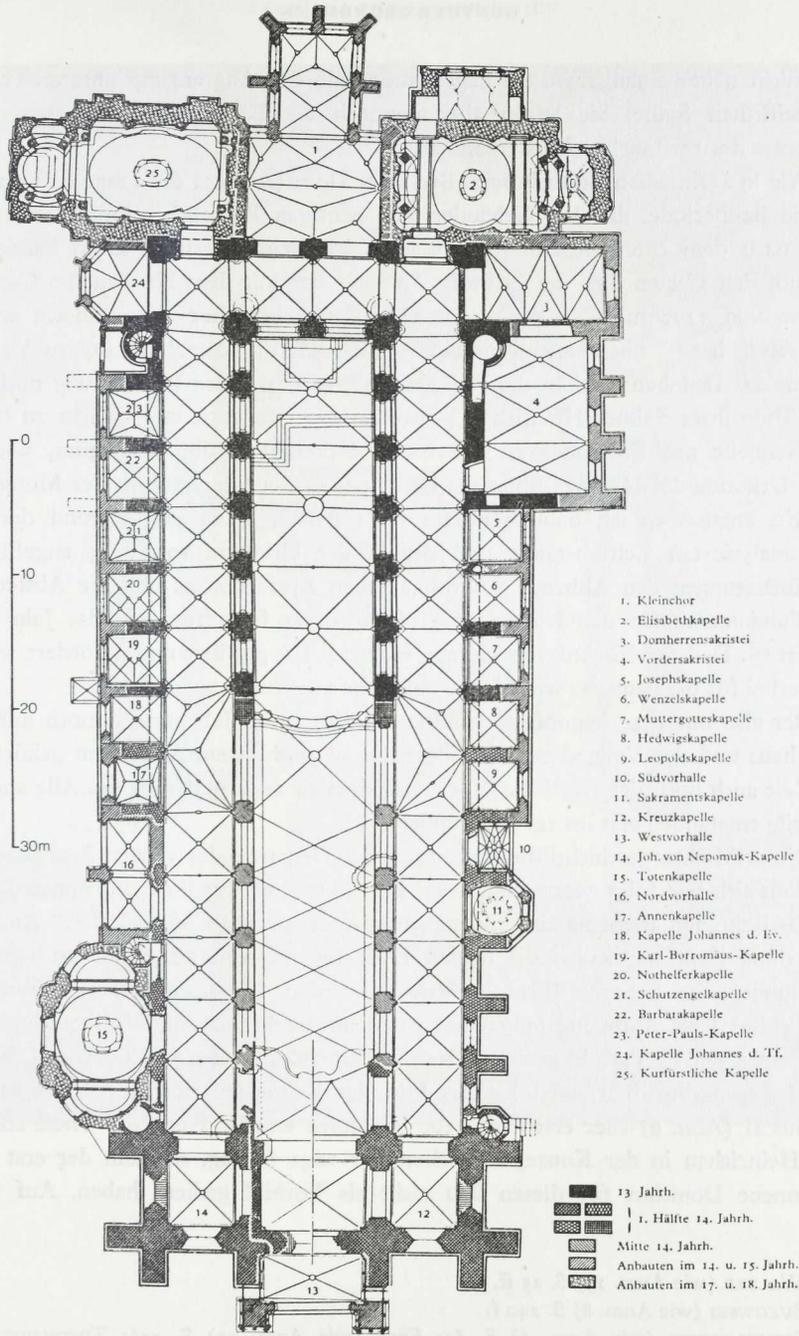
Grundriß des Breslauer Doms (nach L. Burgemeister)
